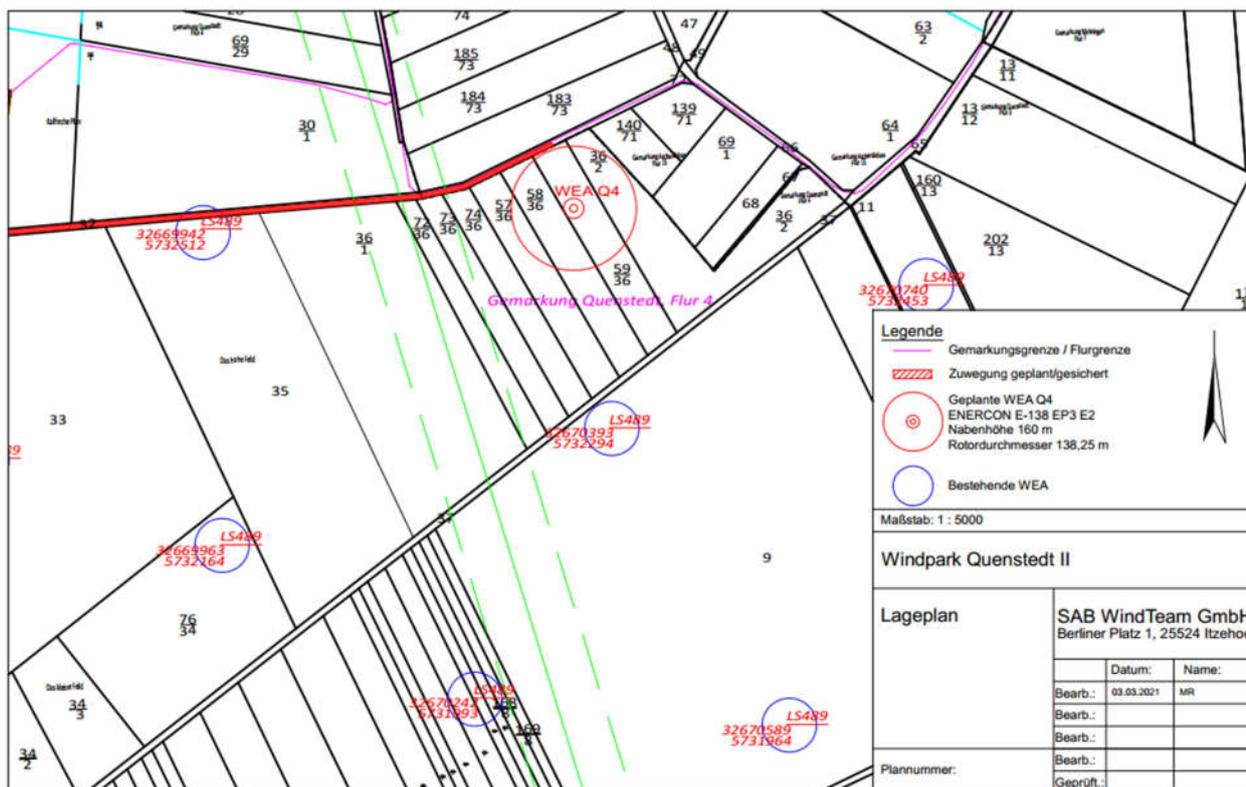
Lageplan WP Quenstedt II, interne Zuwegung
